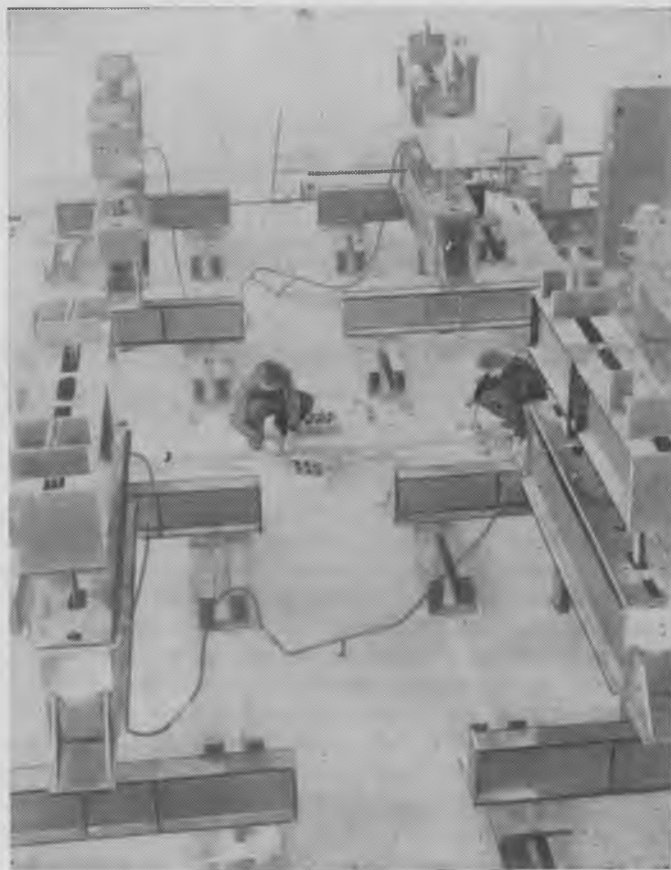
Испытание фрагмента перекрытия распределенной нагрузкой
